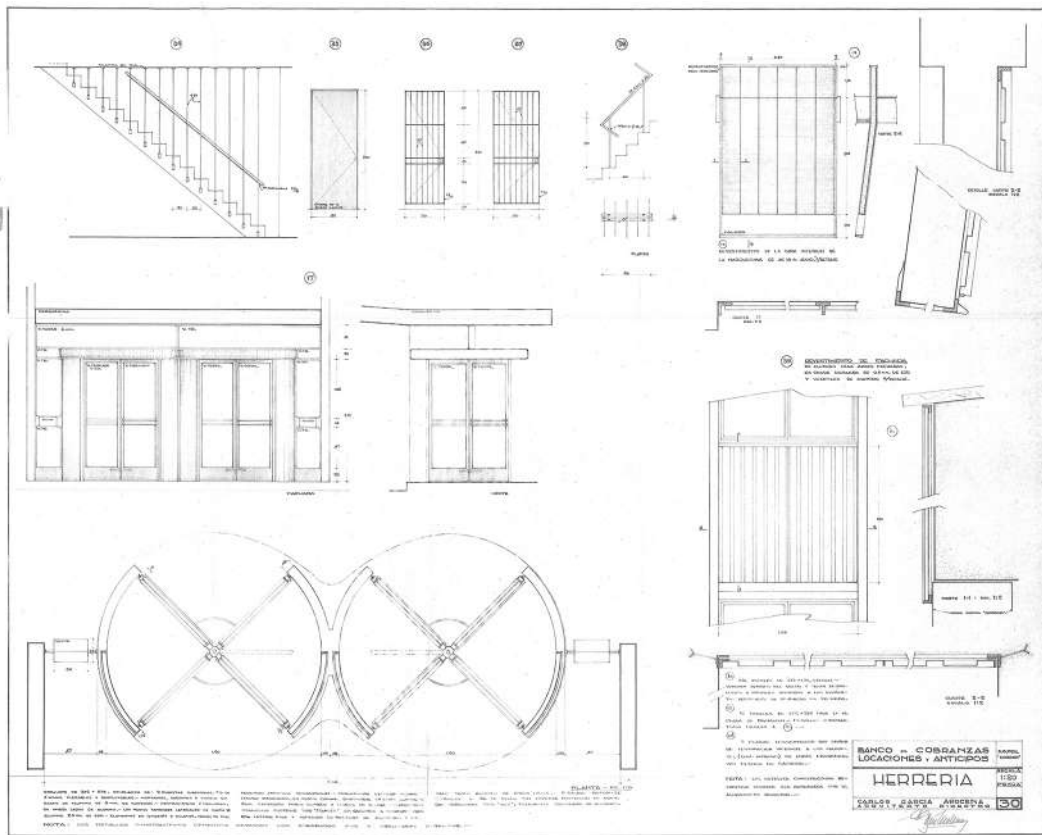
Lámina 30 del proyecto ejecutivo del BCLA. Detalles de herrería: marquesina y spandrel.
